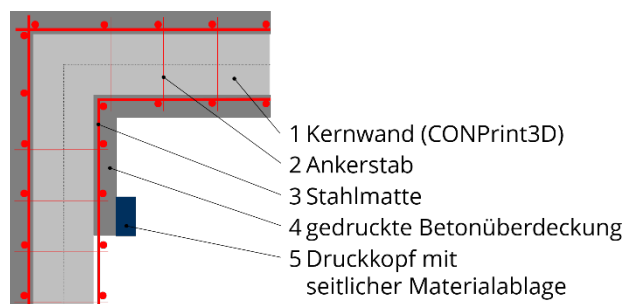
Variante 1 - Prinzipskizze in der Draufsicht
